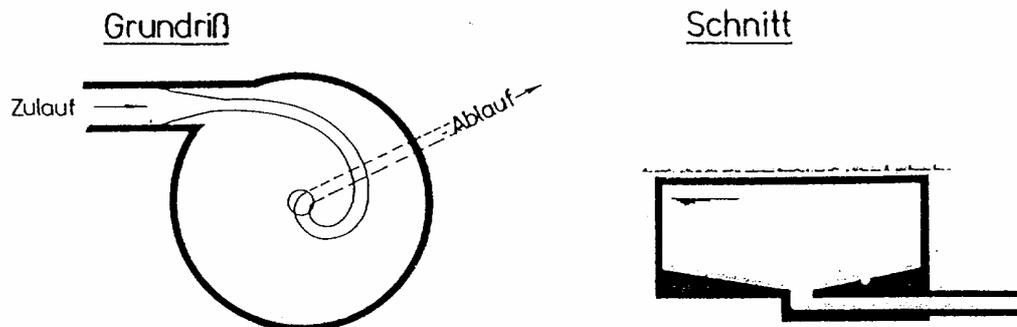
Regenzyklonbecken mit außenliegendem Klärüberlauf
